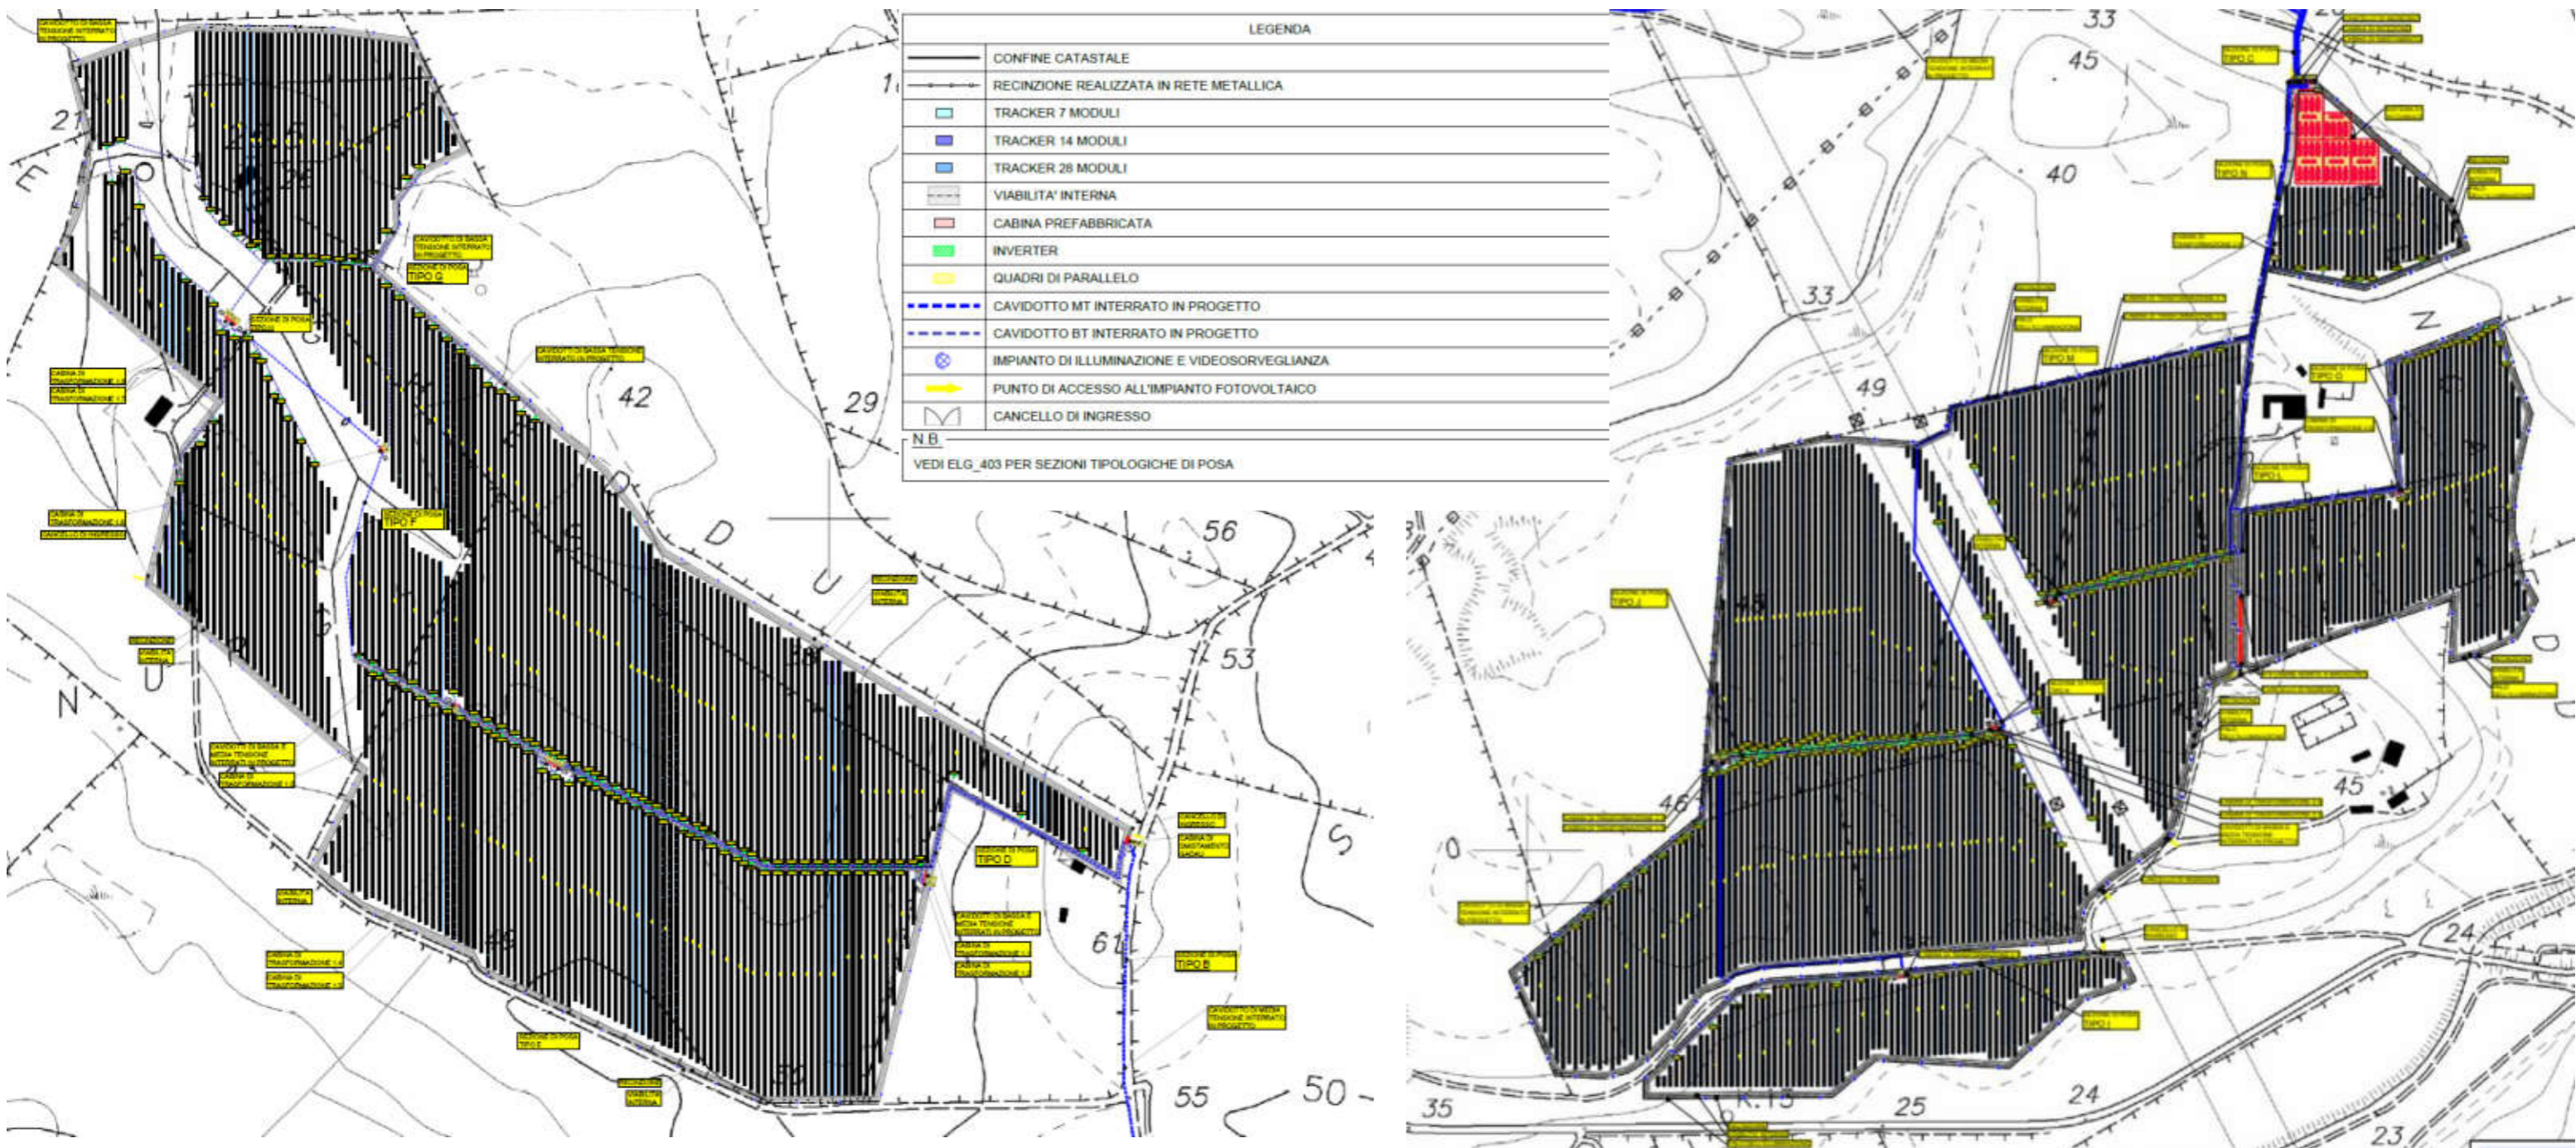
Estratto della Tav. di progetto con planimetria del lotto 1 (a sinistra) e lotto 2 (a destra) su ortofoto
